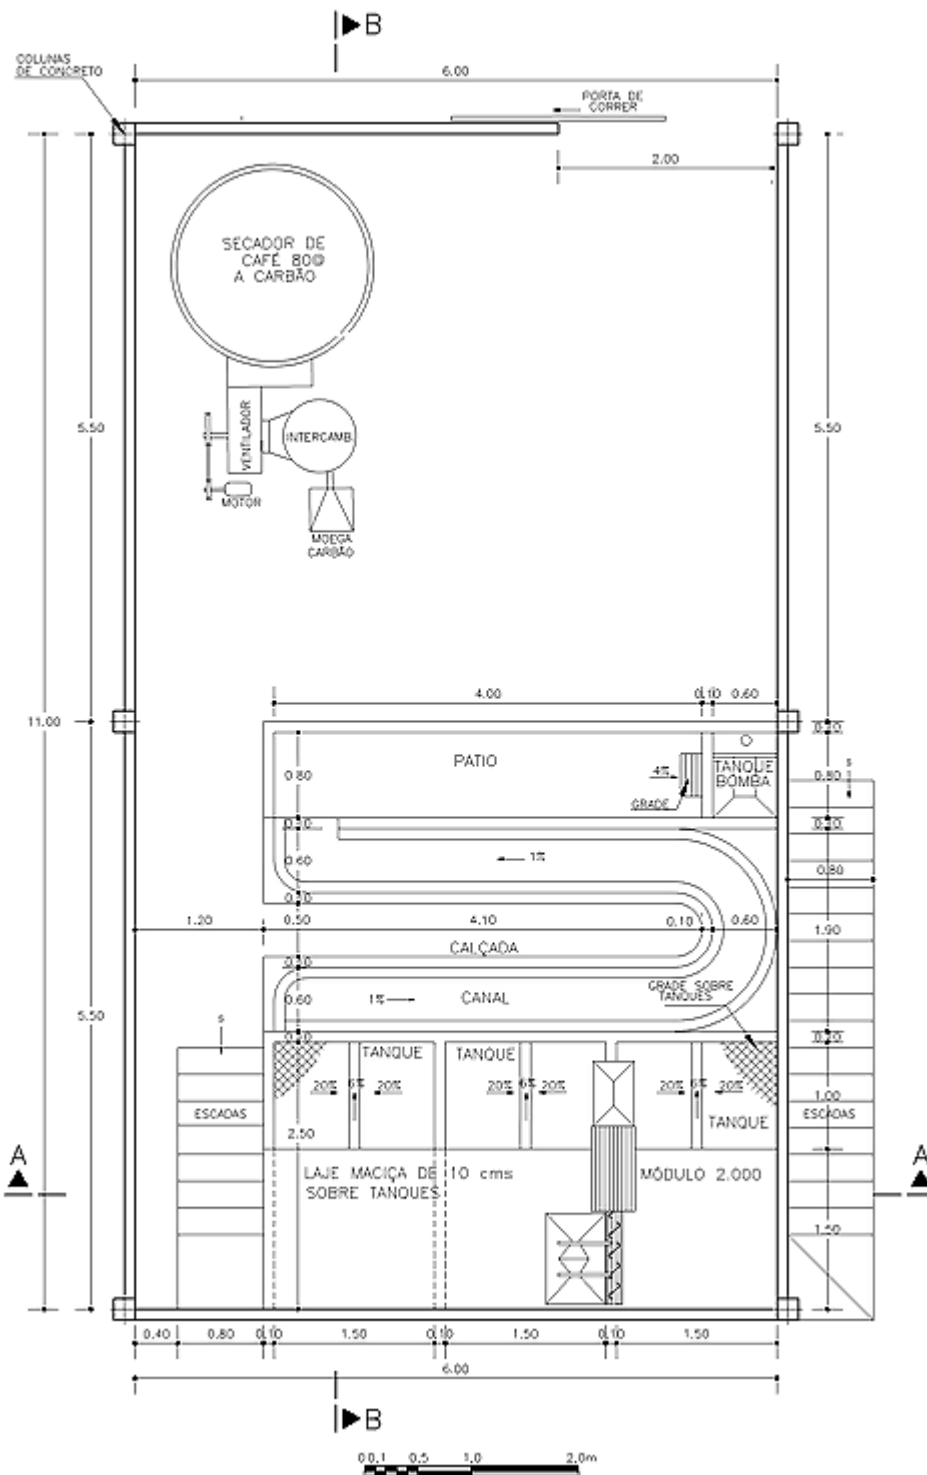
Planta baixa da instalação para processamento úmido de café, no município de Barbosa – tipologia 1.
